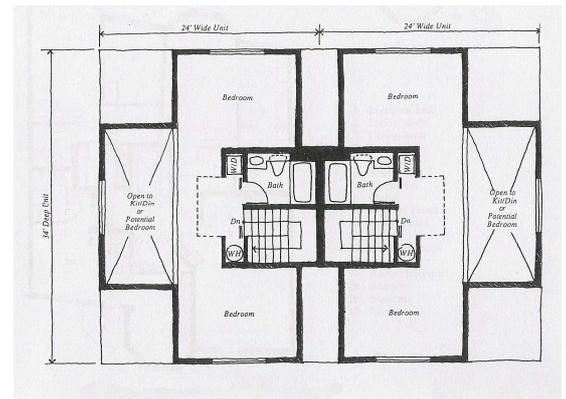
Pianta dell'alloggio B di Pleasant Hill.
